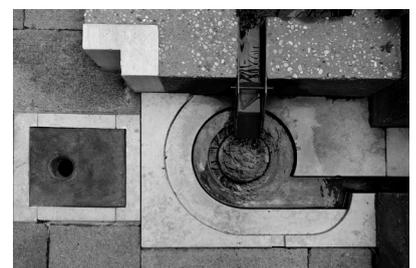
Figura X - Ponto de encontro de canais | Fonte: Acervo FQZ
